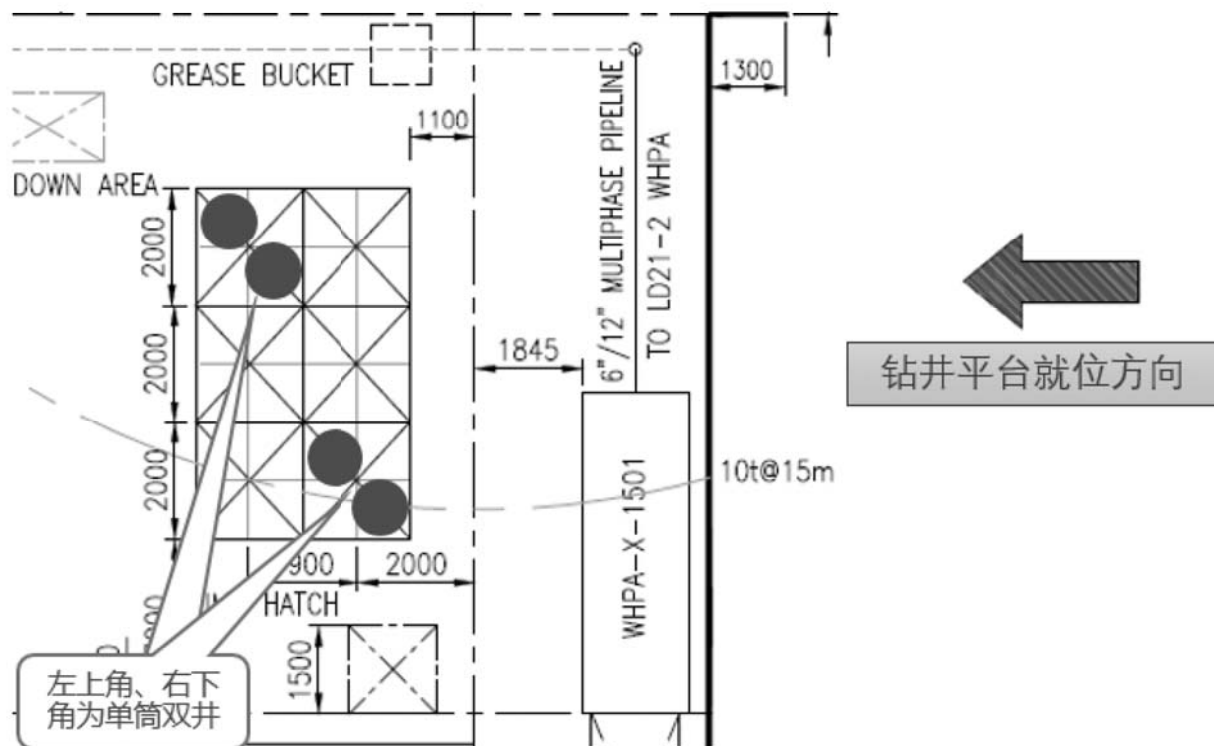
LD29-1WHPA 平台井槽平面布置图
